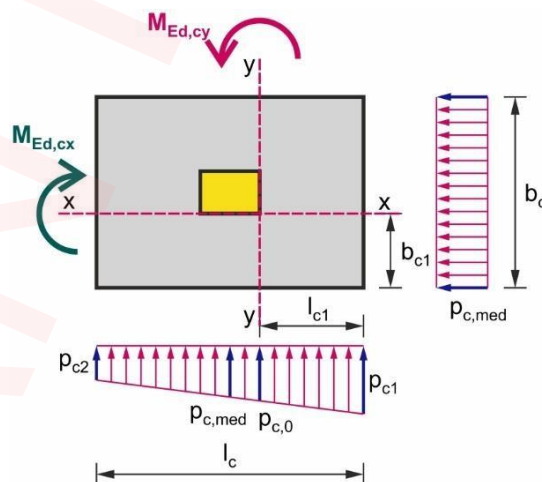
Schema de calcul a momentelor încovoietoare din cuzinet
